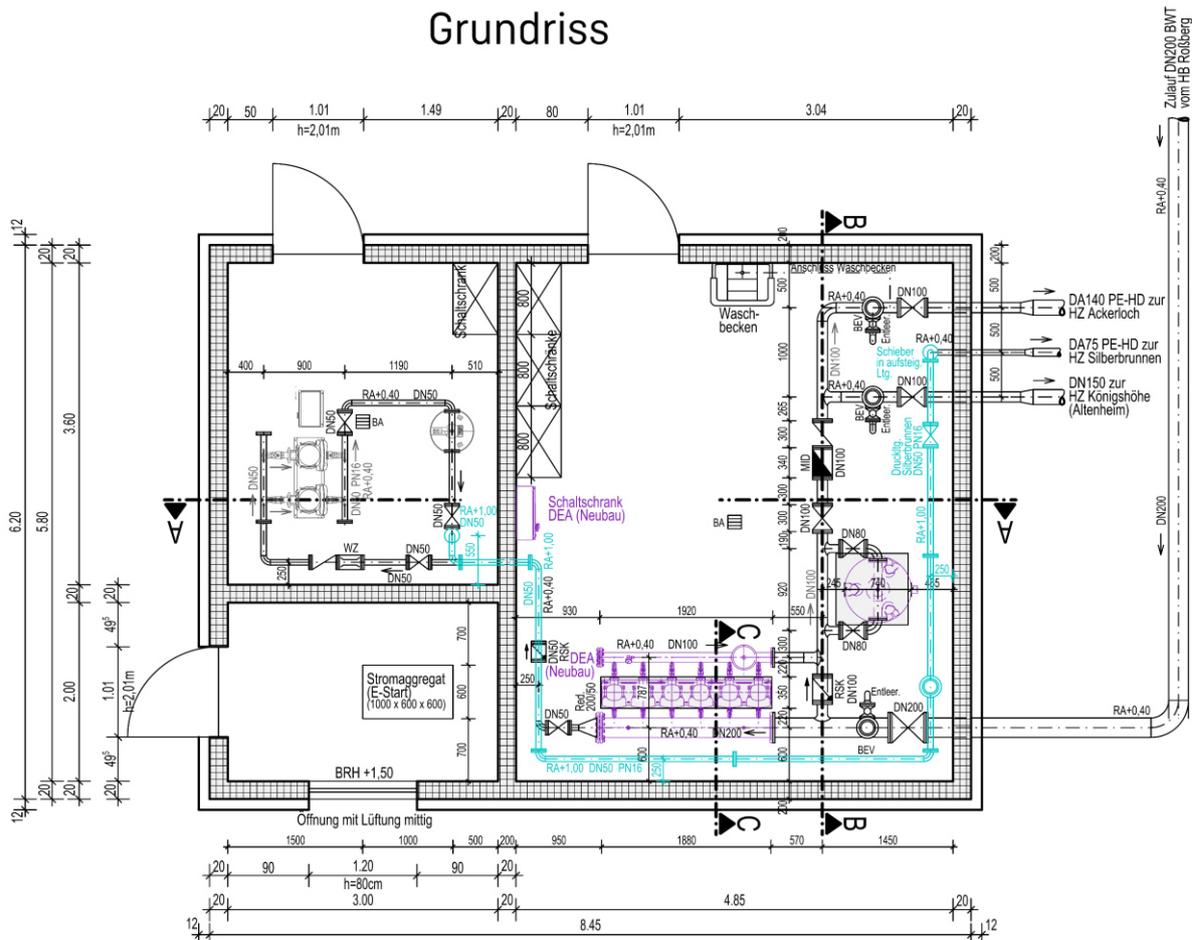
Grundriss des geplanten Pumpwerks mit hydraulischer Installation
